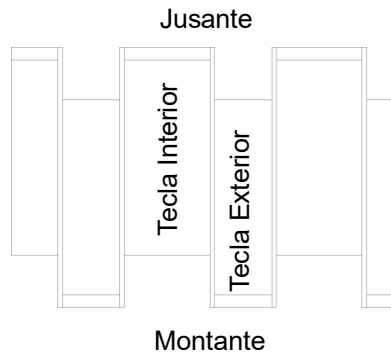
Planta da soleira descarregadora do tipo PKW.
